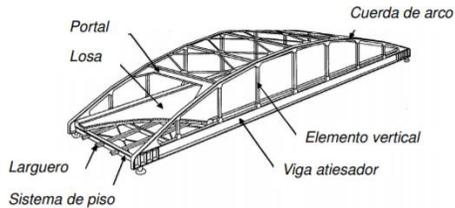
Sistema de viga de arco superior. Fuente: MOPT, (2007)
